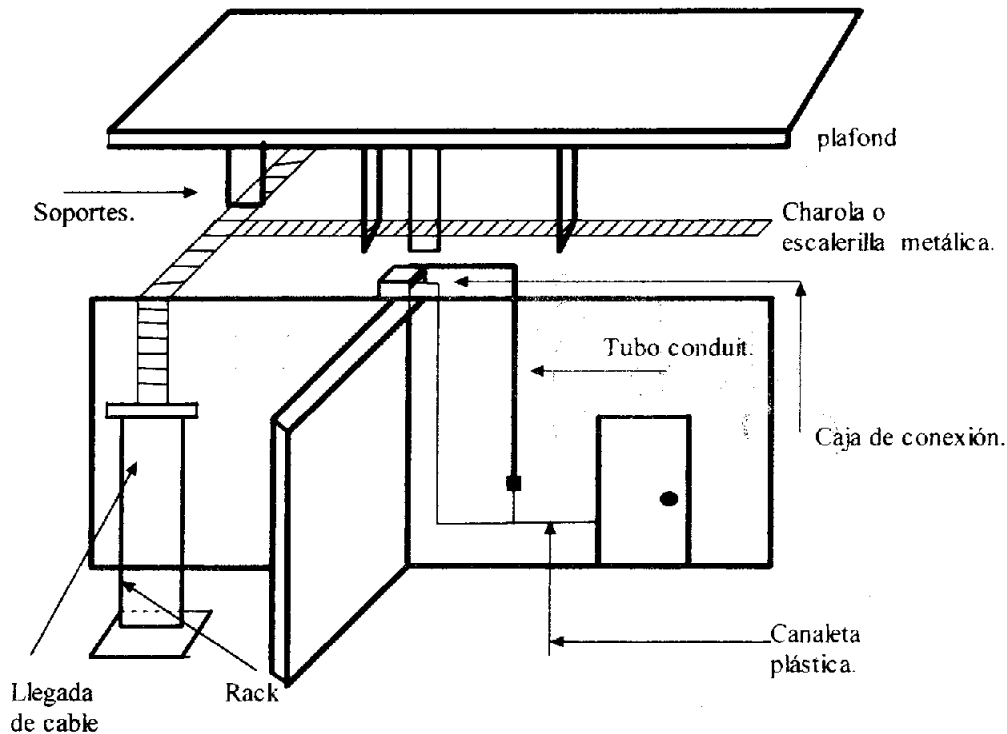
Diseño de cableado horizontal, distribución combinada.
